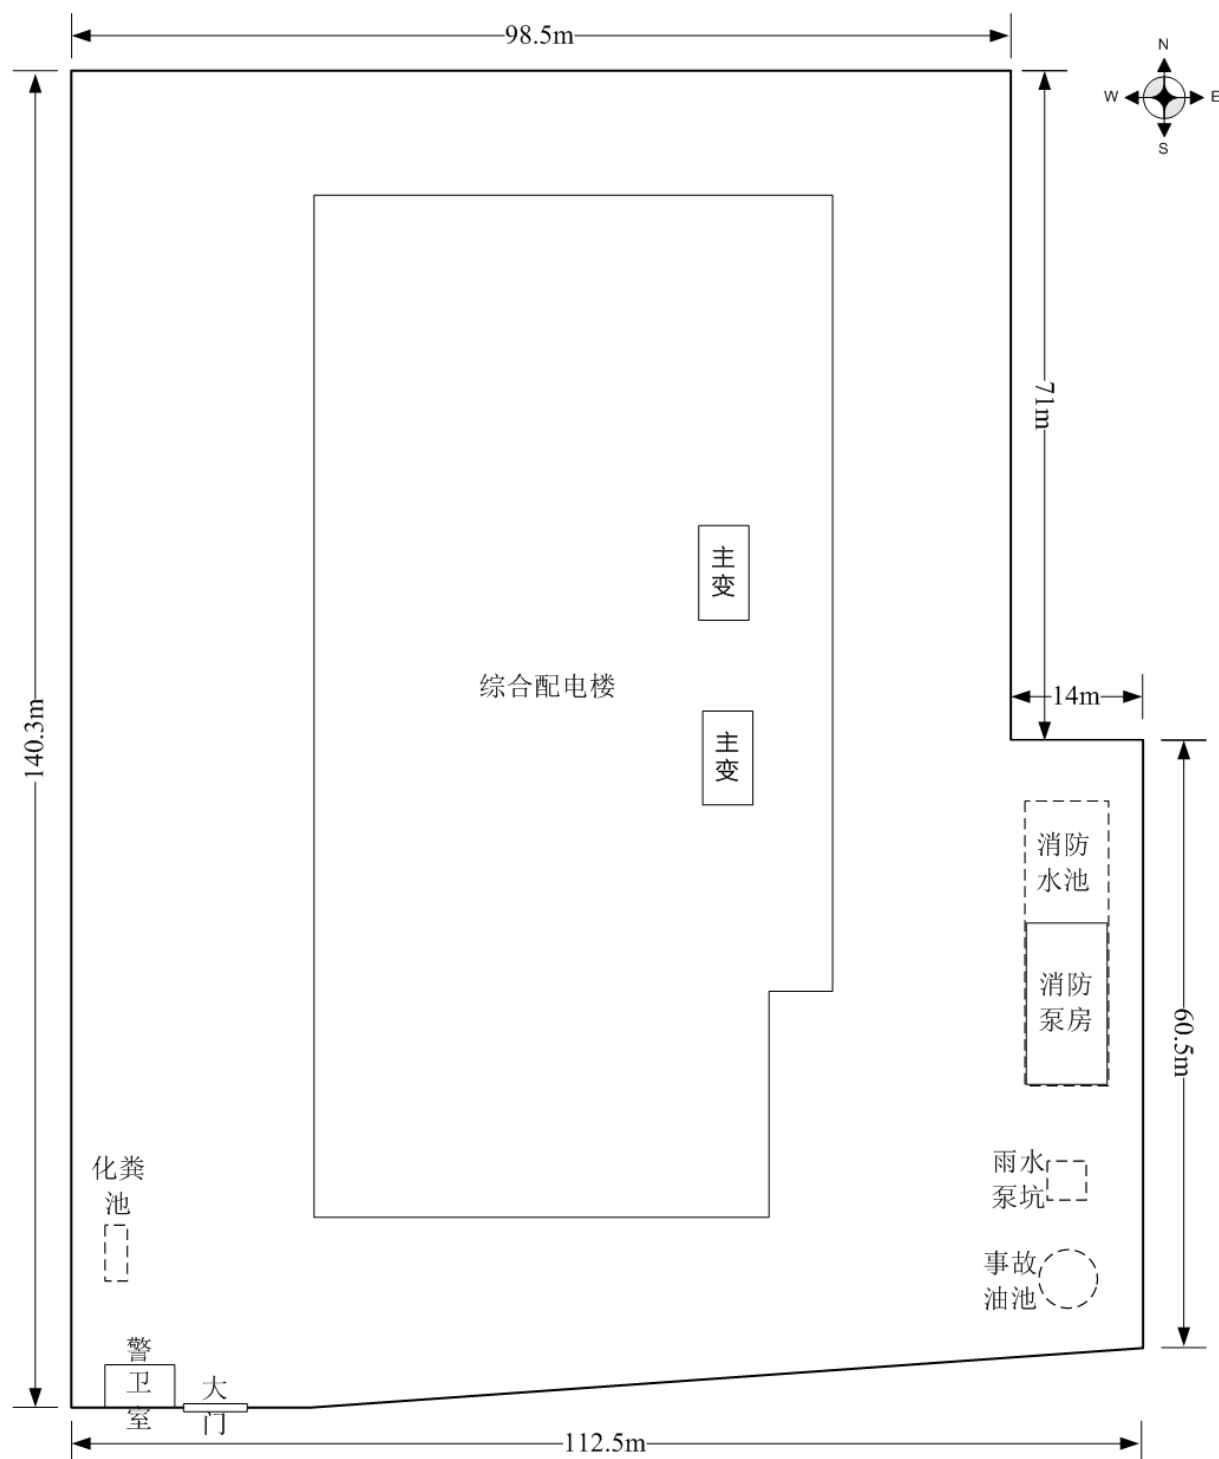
沔渭 330kV 变电站平面布置示意图
